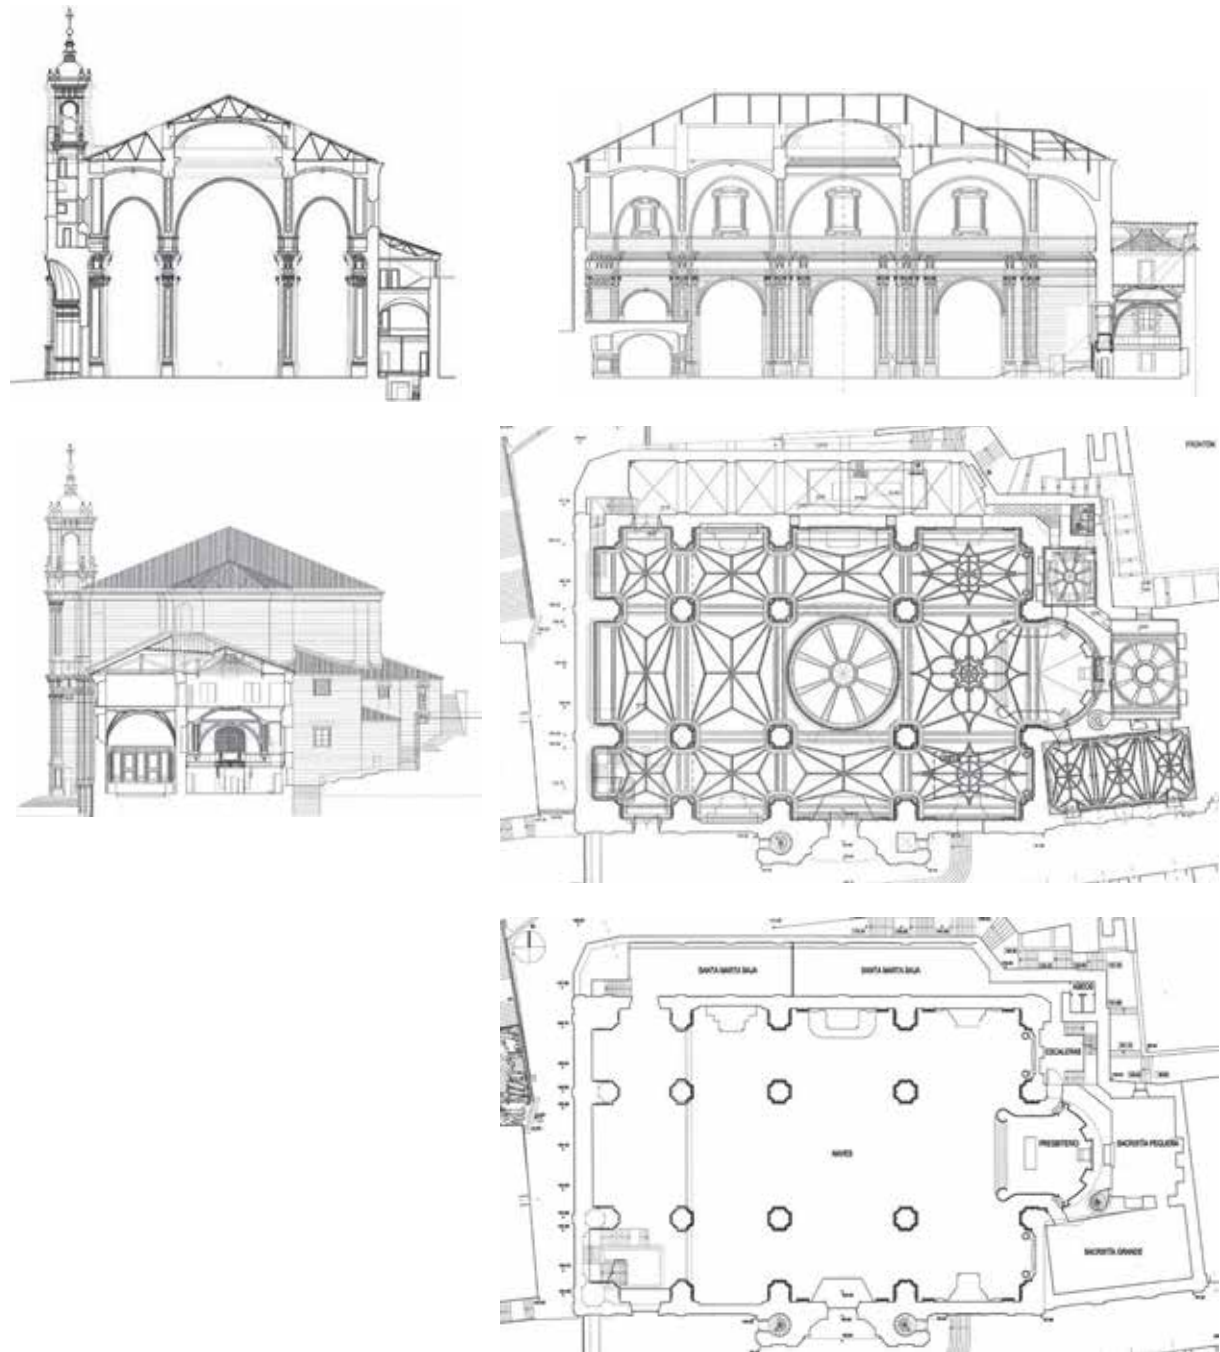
a 89 Ramón Ayerza, arquitecto, plantas y secciones de la Iglesia Santa María del Coro de San Sebastián, 2007-2009, DFG. Las dos primeras representan las secciones transversal y longitudinal por los ejes centrales, la tercera la sección transversal por la sacristía; la cuarta presenta la planta de las bóvedas y la quinta la planta con las naves y la entreplanta del coro. La estructura de madera de bajo cubierta ha sido sustituida por una metálica.
